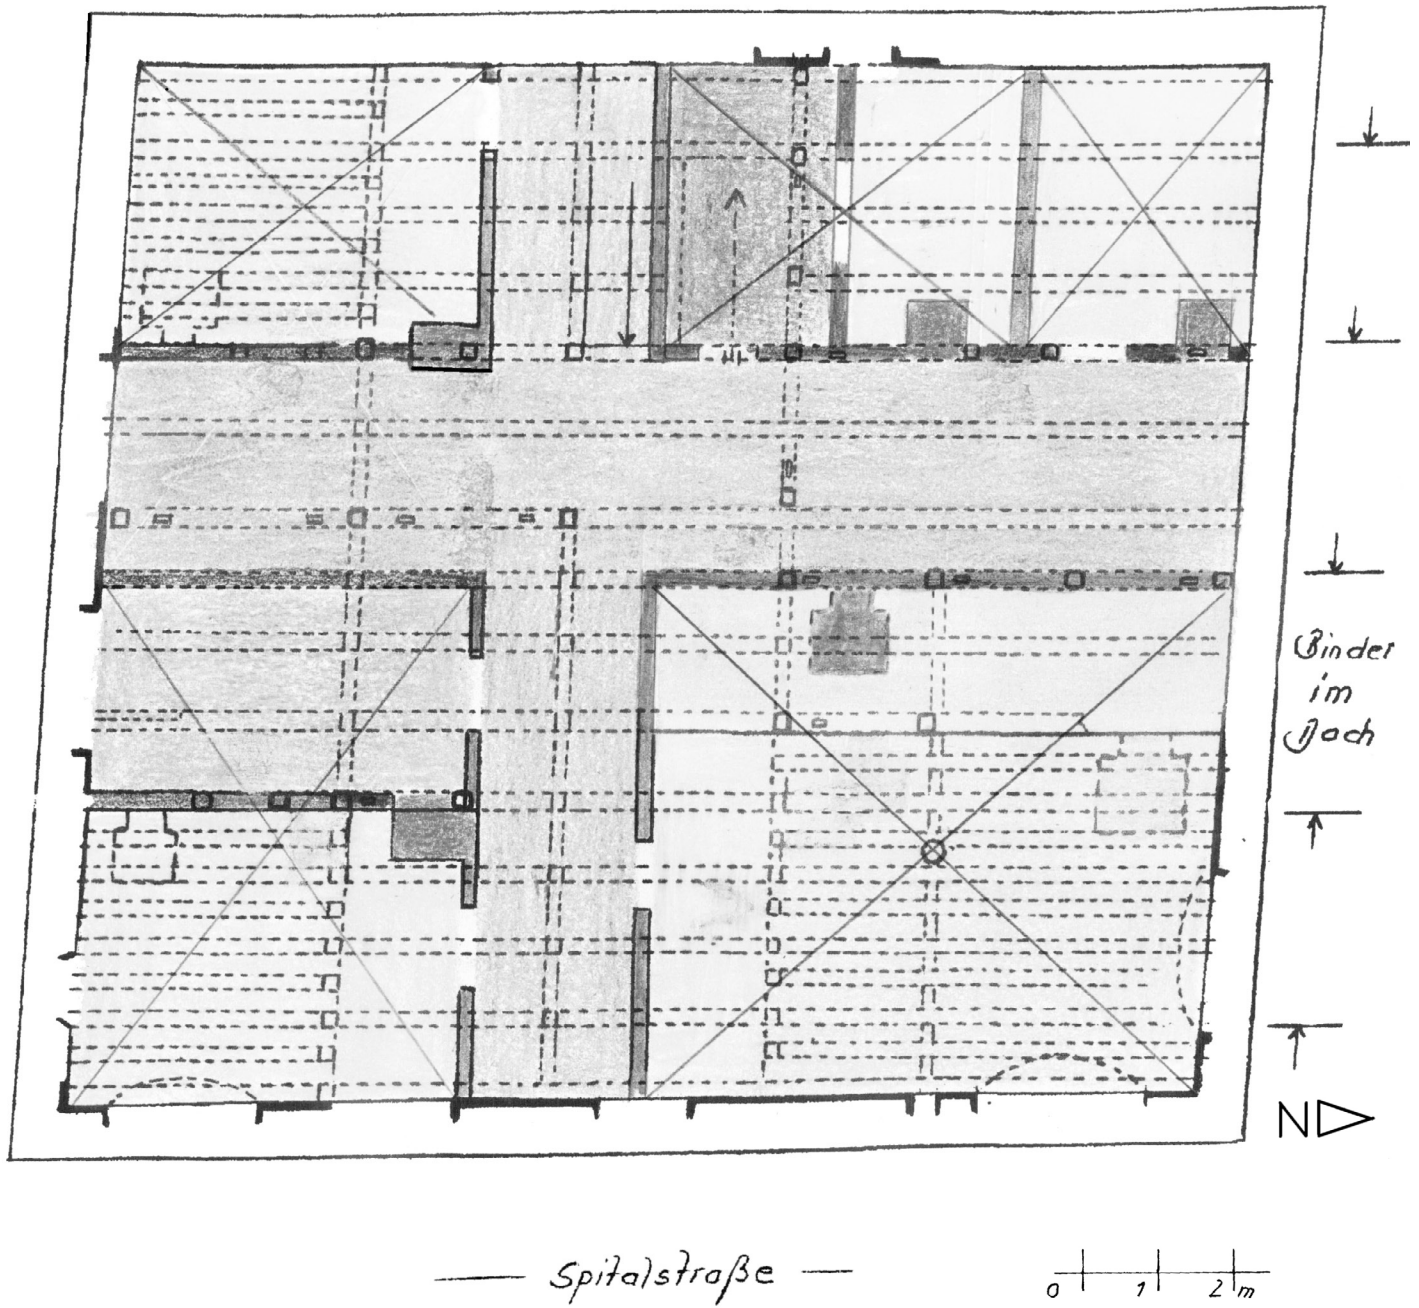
Spitalstraße 33, Grundriss 1. Obergeschoss, 18. Jh., Rekonstruktion.
